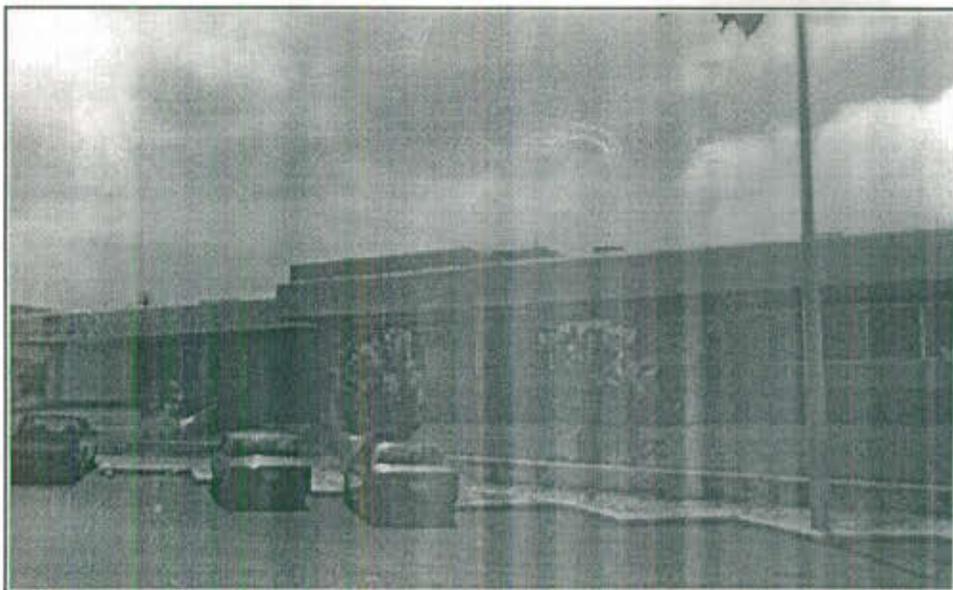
VISTA FRONTAL DE EDIFICIO DE ADMINISTRACIÓN Y APOYO ACADEMICO DE F.I.M.C.M.
